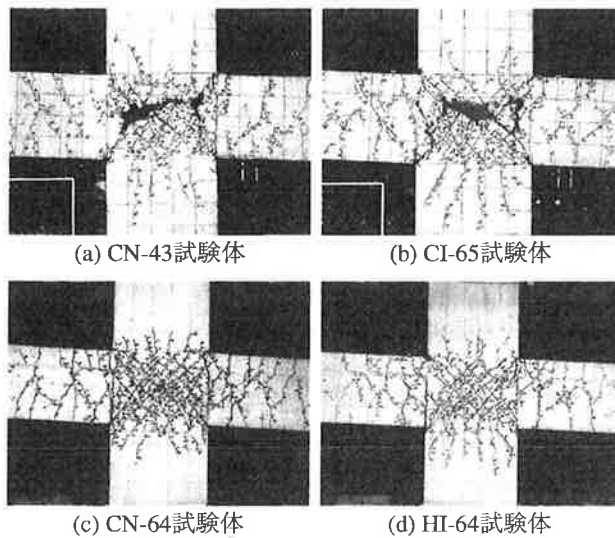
層間変位角 $R = 1/25$ 時ひび割れ状況
